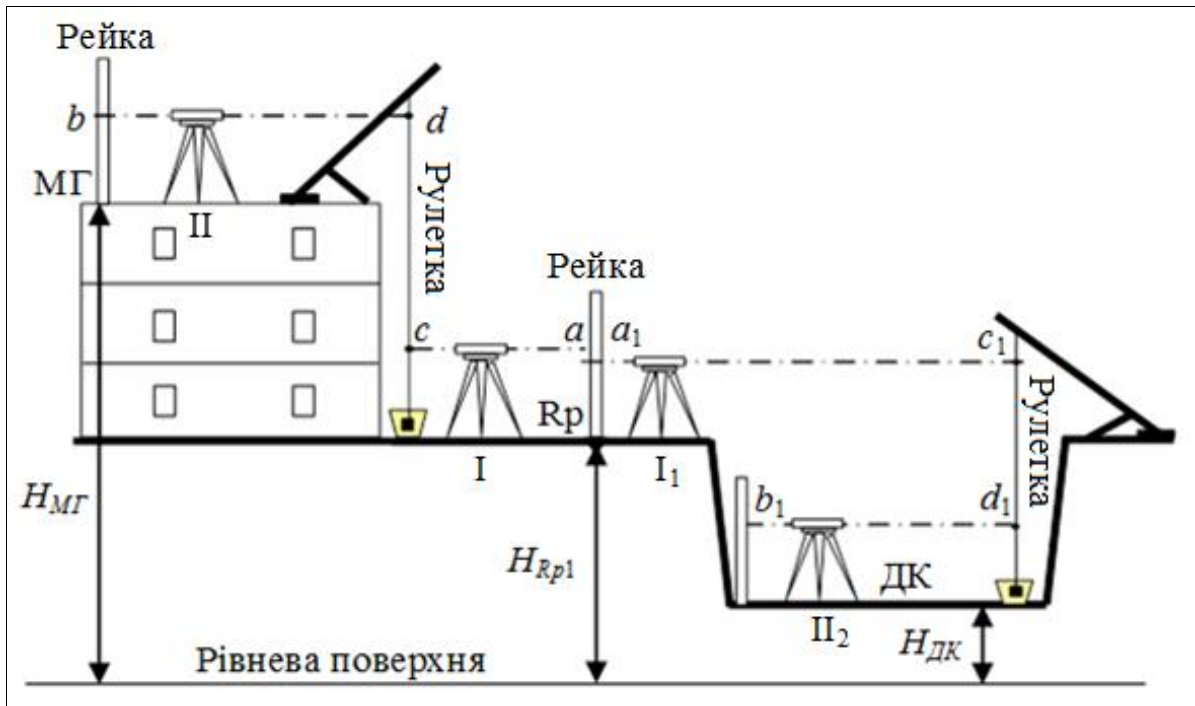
Схема передачі позначки на монтажний горизонт (МГ) та на дно котловану (ДК)
